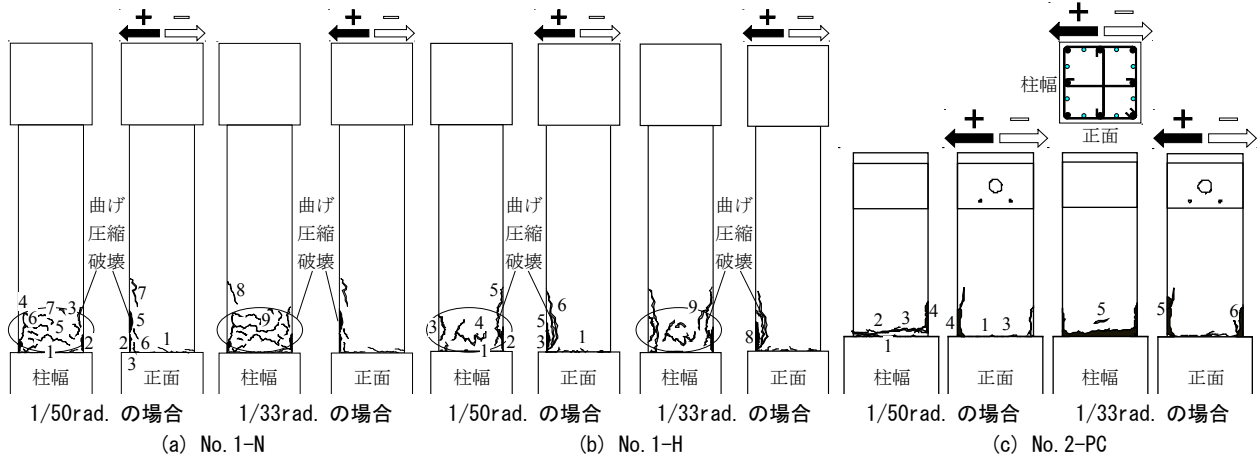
試験体ひび割れ (1/50rad. 1/33rad. の場合)
